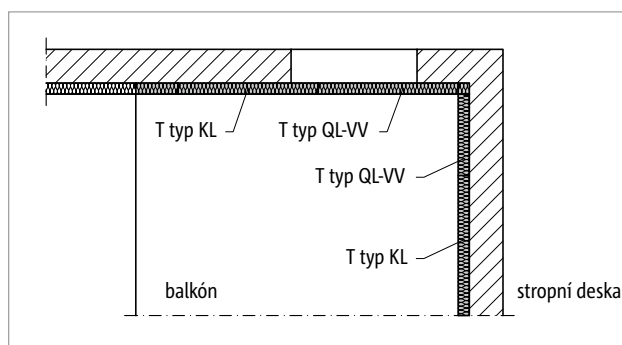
Schöck Isokorb® T typ KL: Volně vyložený balkón
